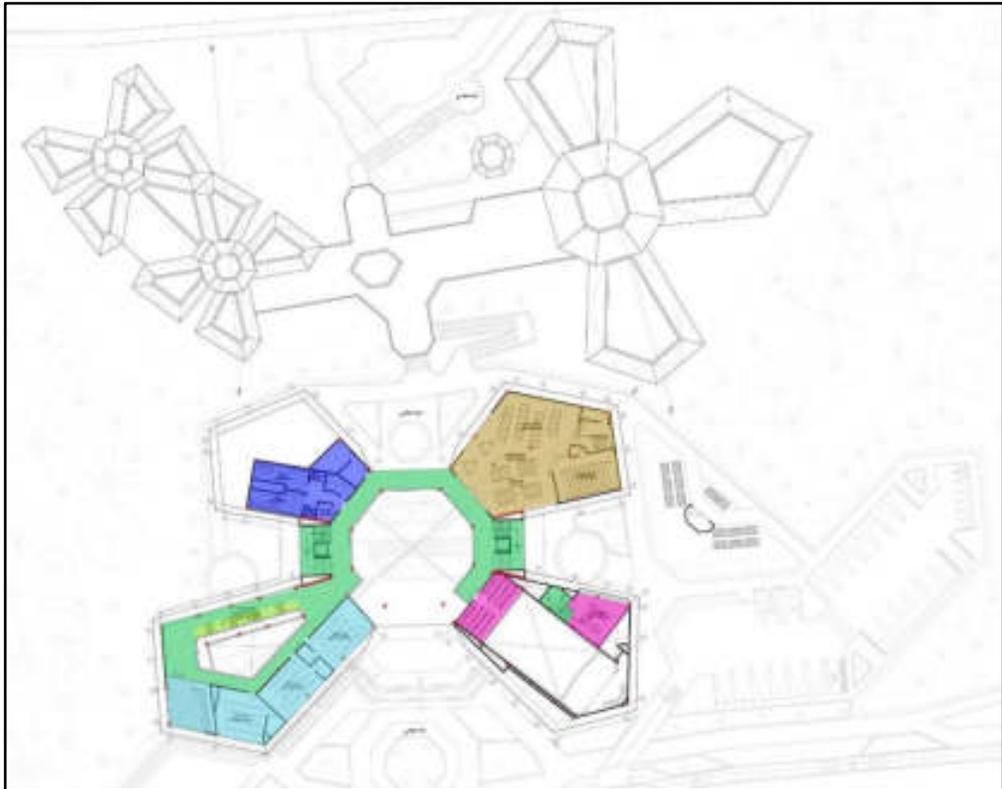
Zonificación para planta de primer piso. (Ver anexo 22).
